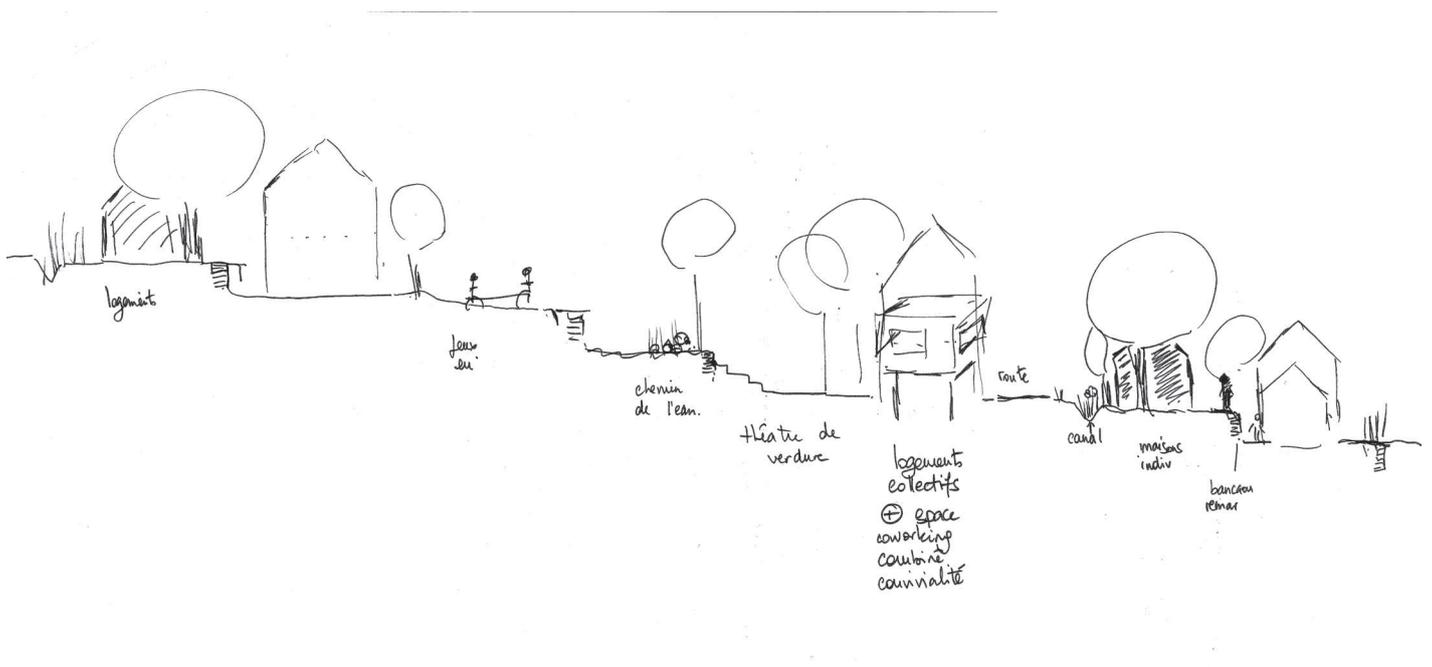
Coupe longitudinale proposée par le 2ème groupe des «architectes paysagistes» sur Coudoux
